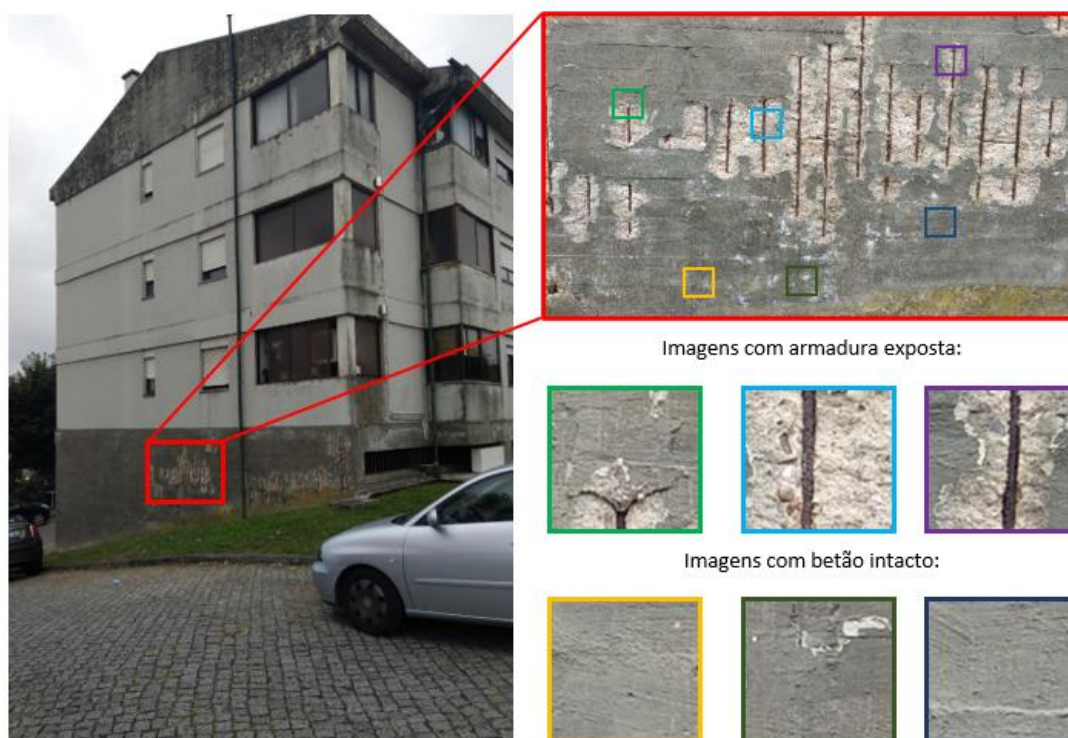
Recolha de imagens de armaduras expostas, Penafiel
